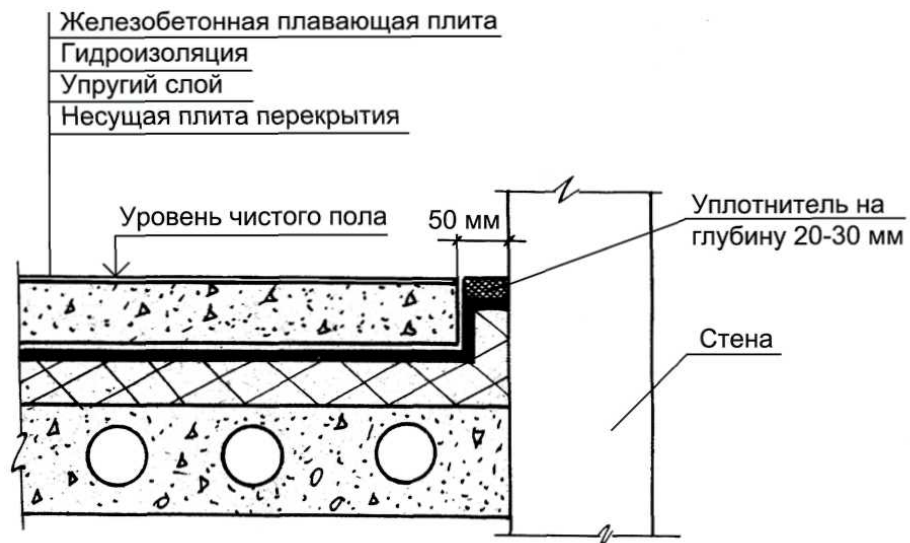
Конструкция пола на упругом основании и его стыка со стенами
